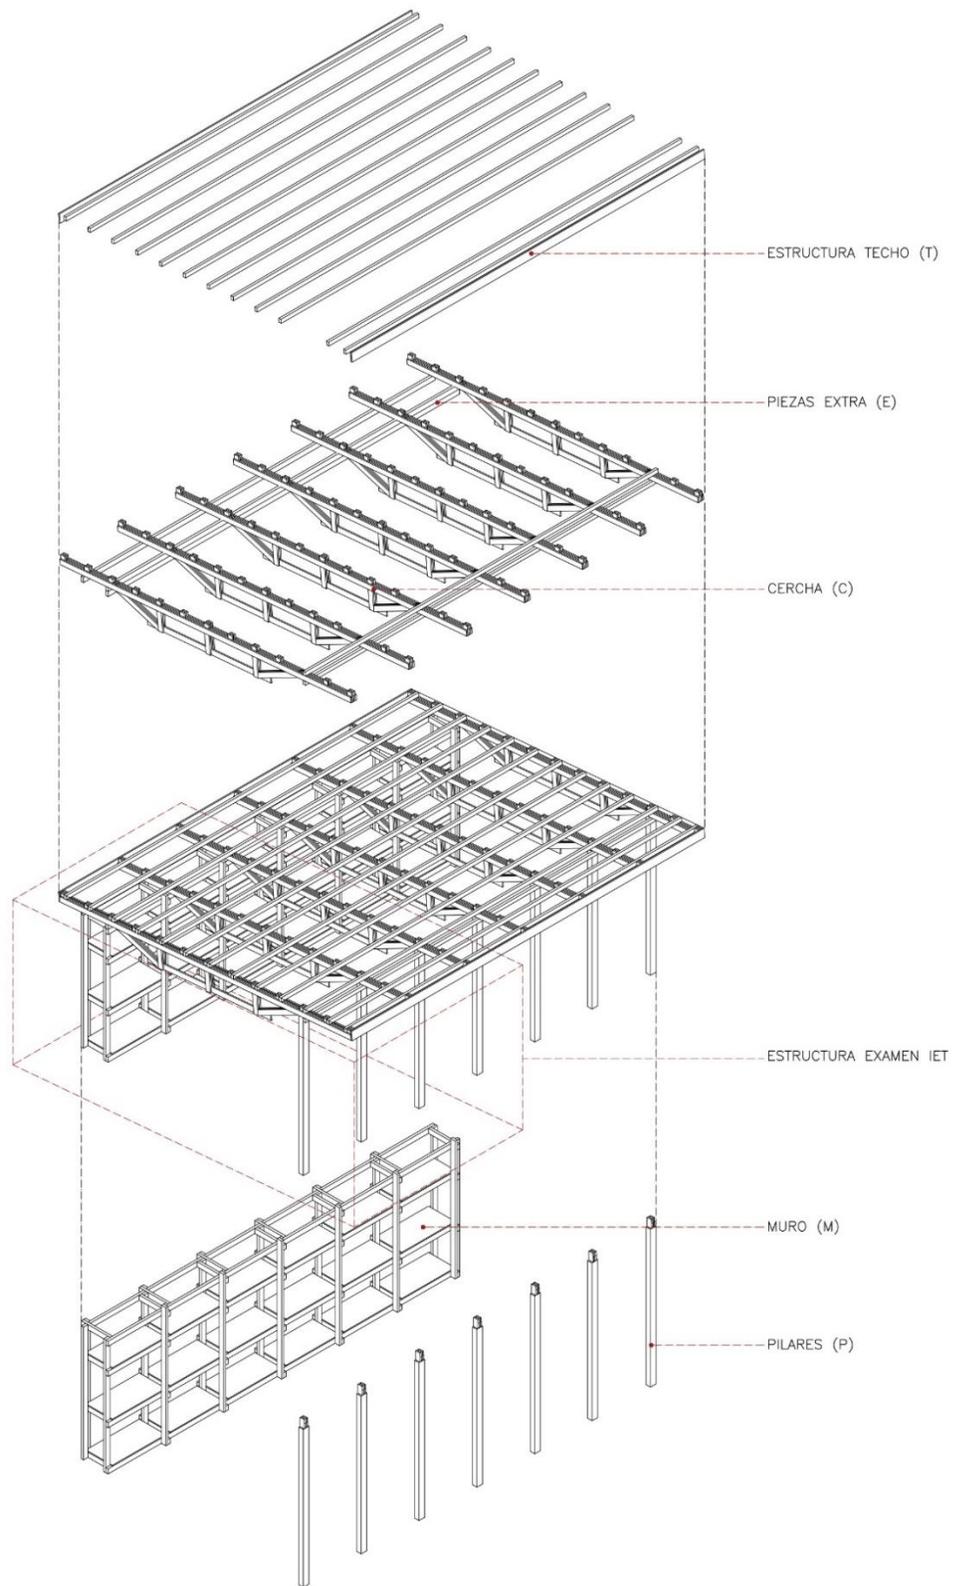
Equipo Introducción a la Construcción (2017) Axonométrica explotada de cubierta en base a componentes prefabricados.
